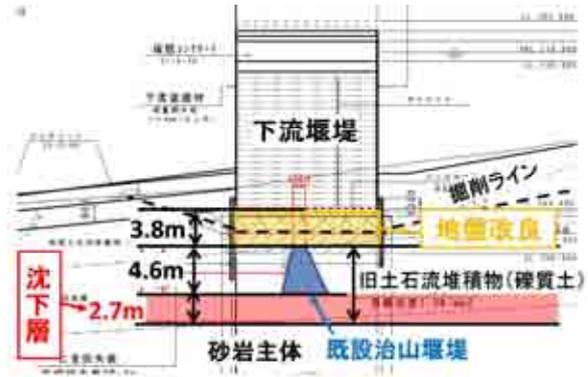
地盤改良及び既設治山堰堤を含む縦断面図
